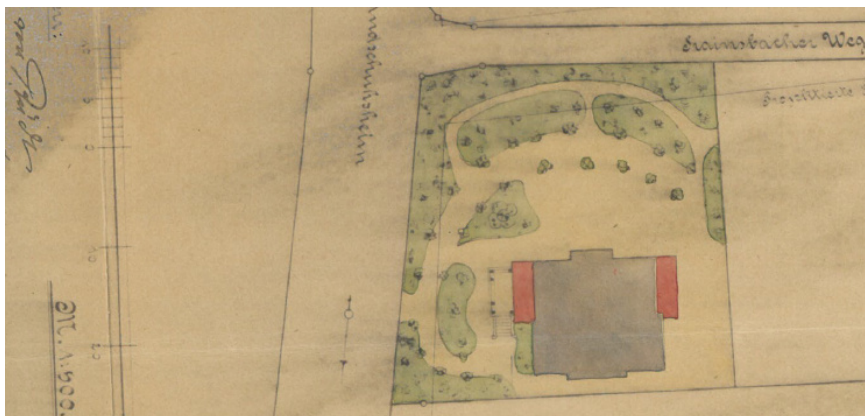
Lageplan mit Erweiterungsplanung - damals Handschuhsheimer Landstraße 50
